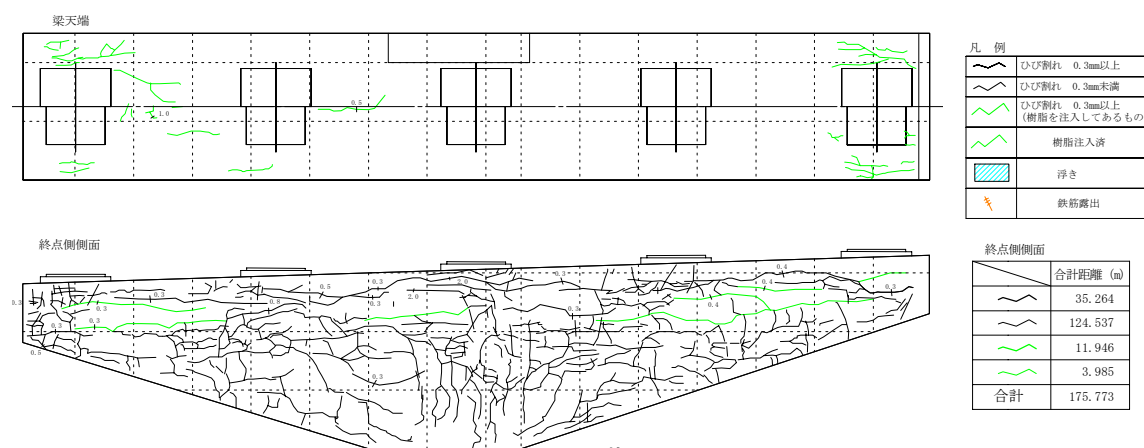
表面保護工除去後のひび割れ状況図
